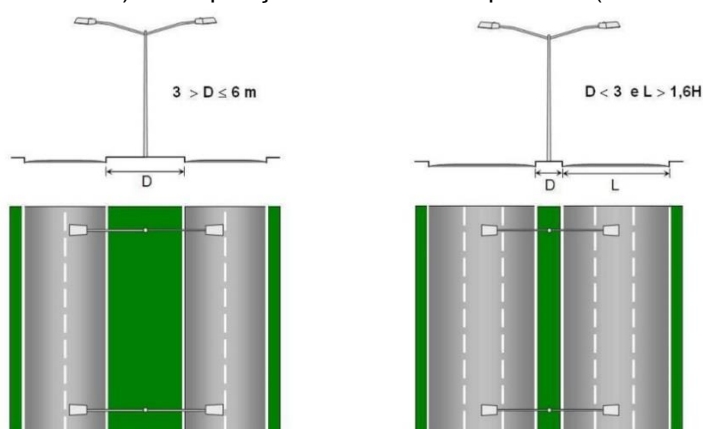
Croqui (planta baixa) da disposição das luminárias públicas (canteiro central)
